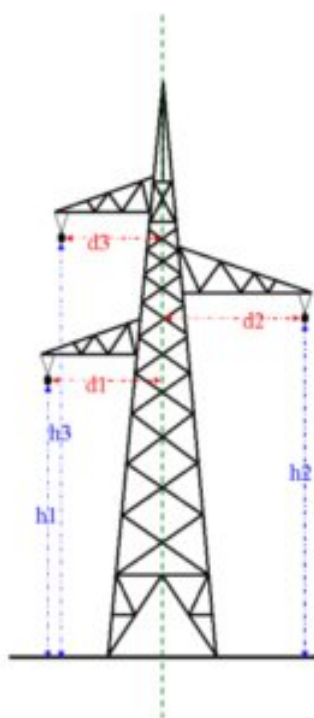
Traliccio tipo considerato nella progettazione delle linee elettriche dalla cabina di trasformazione alla stazione di smistamento.
